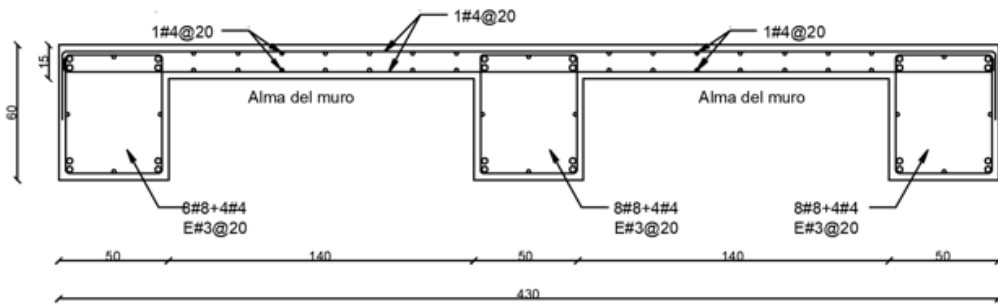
Ejemplo de sección transversal de muros E por nivel de fachada Norte y Sur (adaptado de SRE, 1963).
